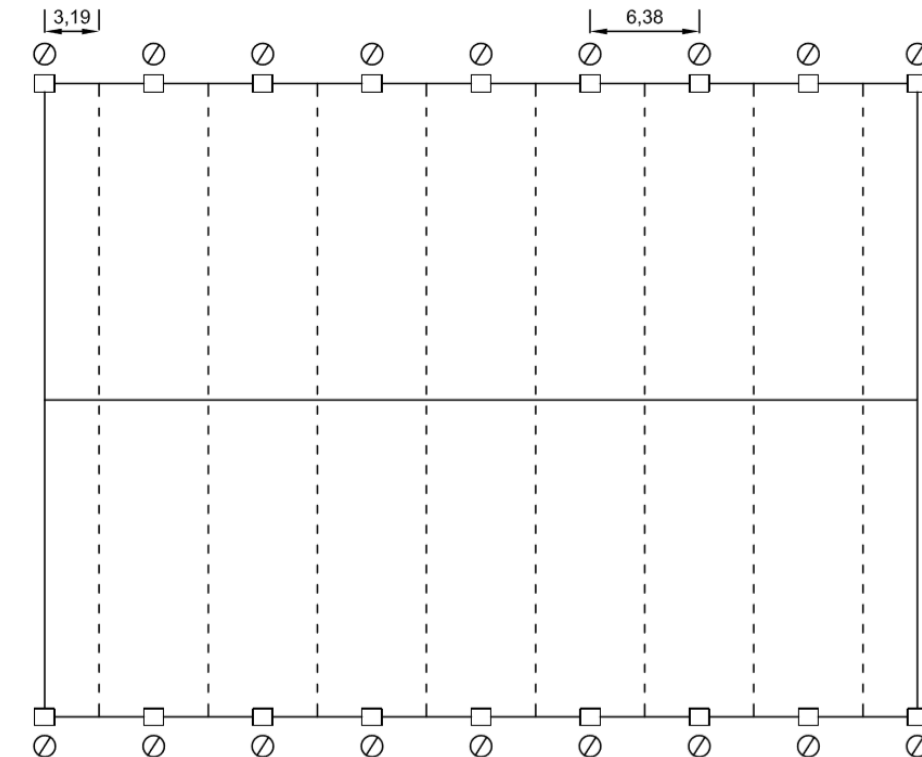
Planta exterior pabellón. Distribución de bajantes de aguas pluviales.
